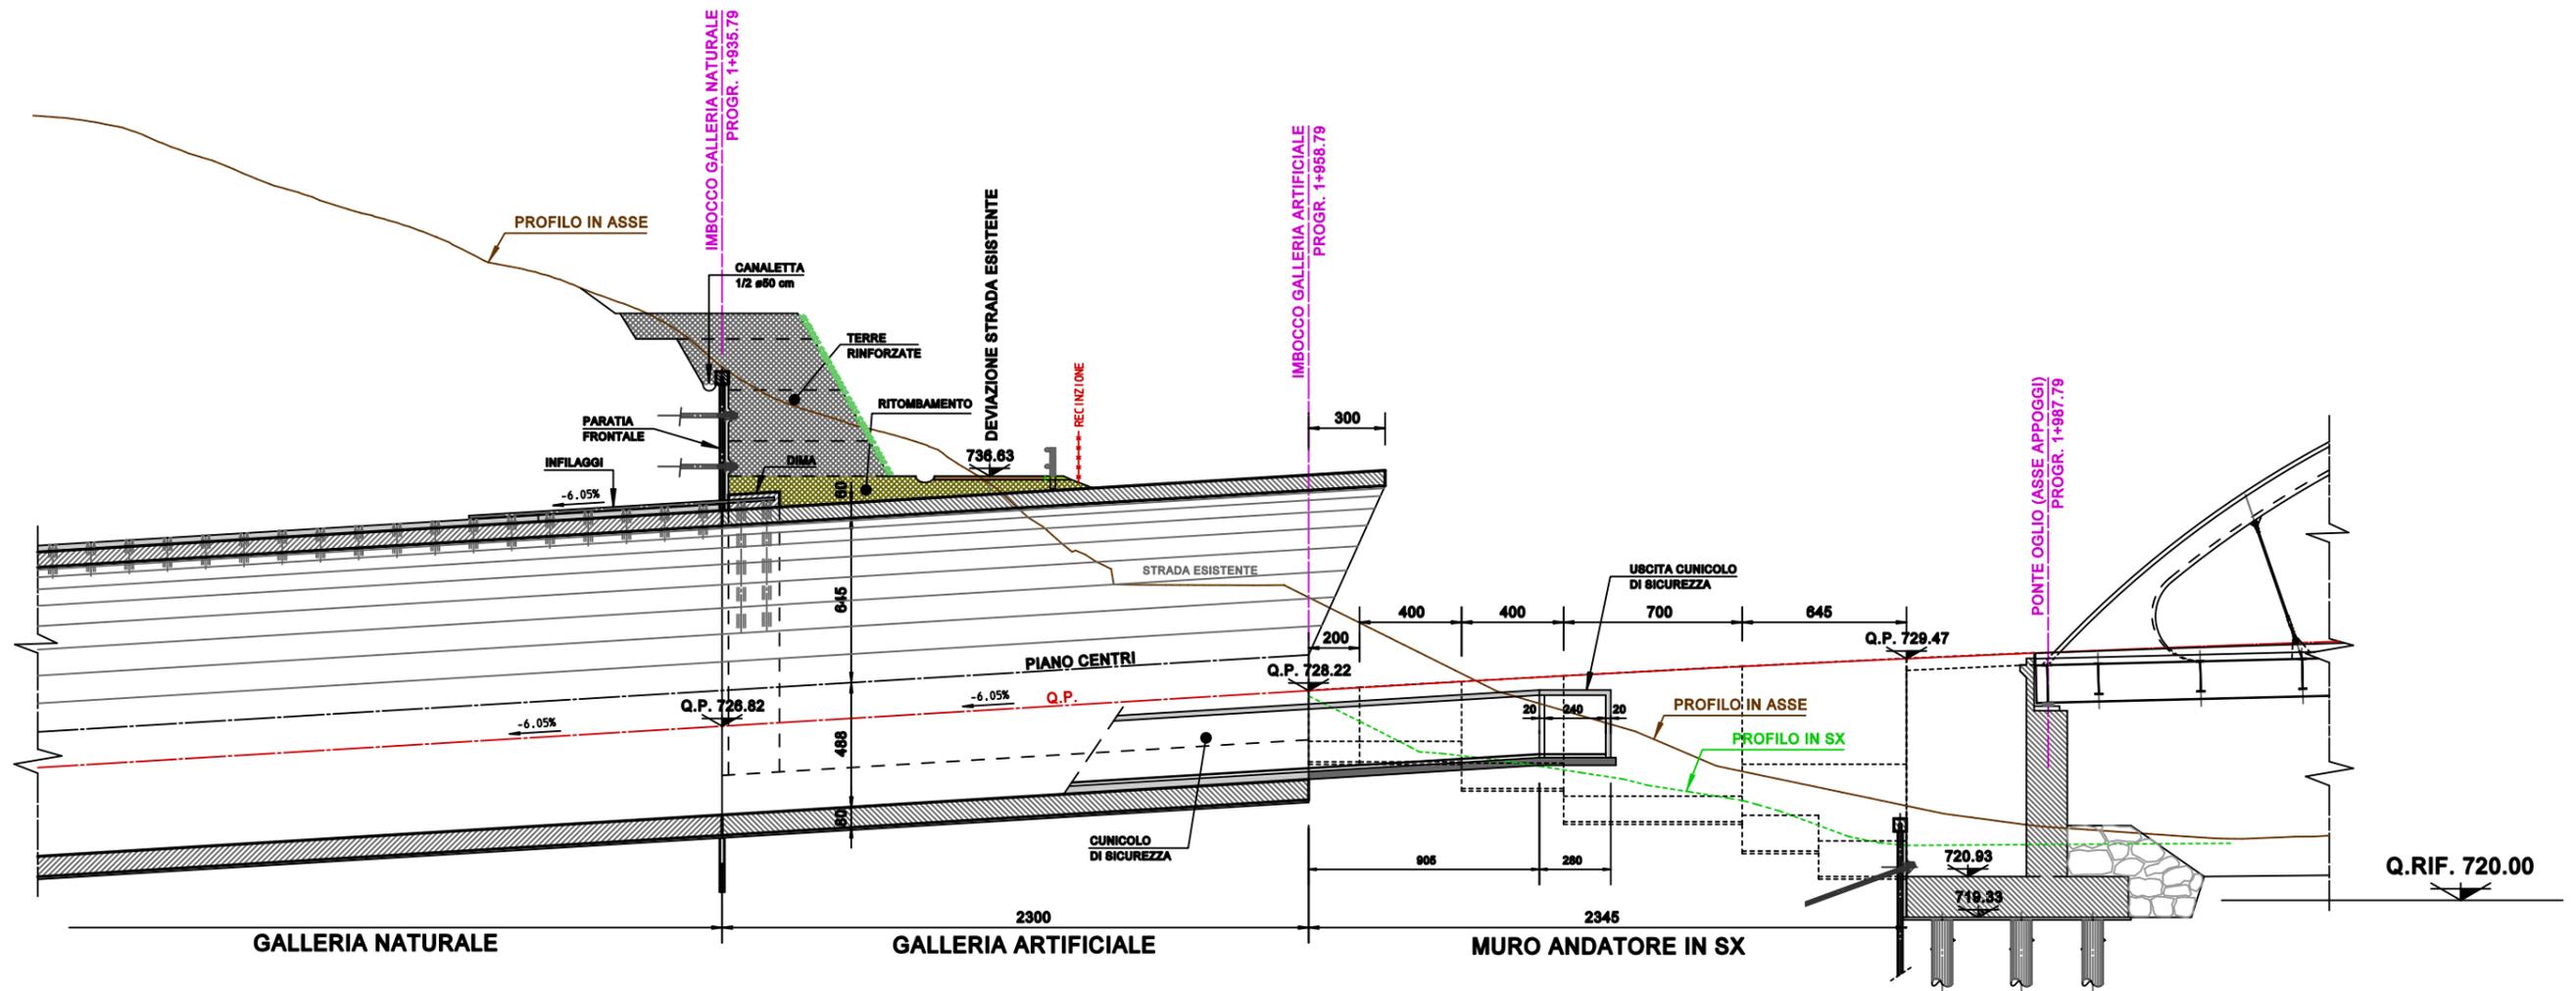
Galleria naturale Imbocco – Sistemazione finale – Sezione in asse galleria
